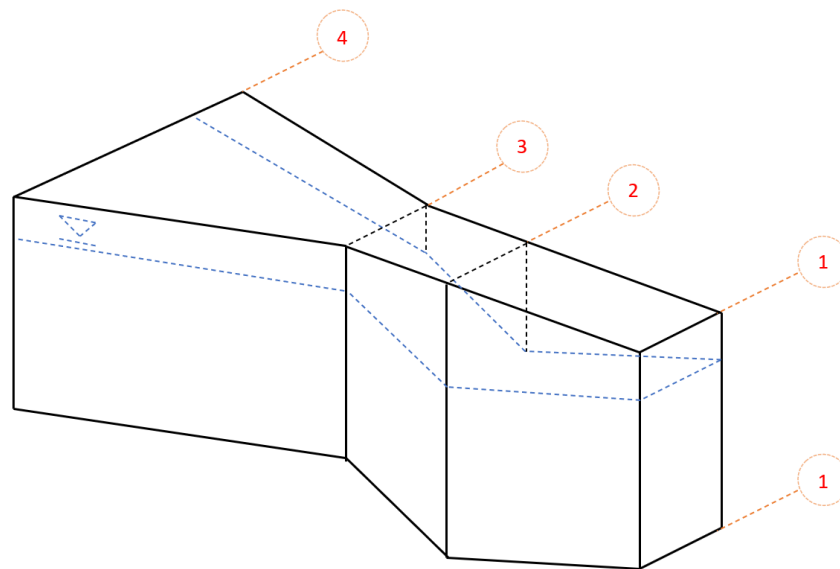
Secciones transversales en una vista 3D de la canaleta Parshall
